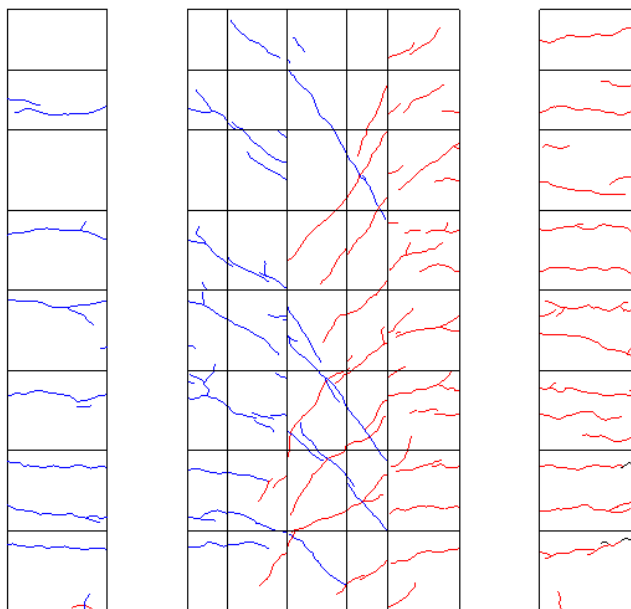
R=1/133②ひび割れ図
